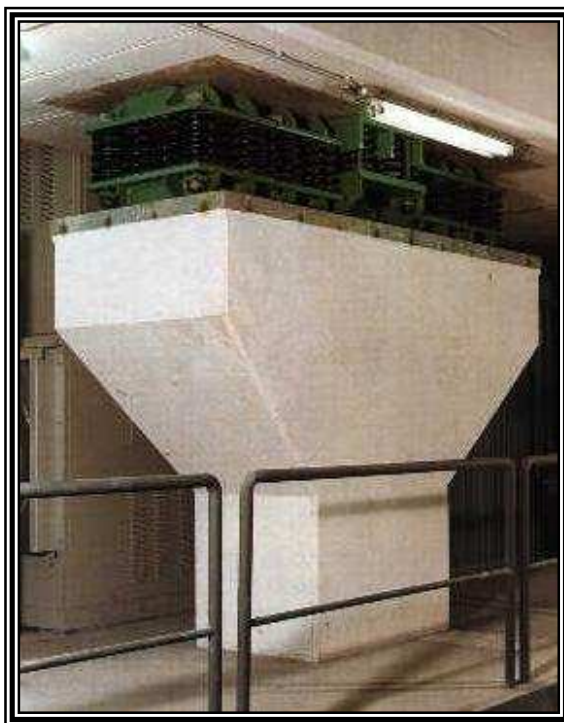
Apoyos de resorte bajo una turbina de una planta de poder.
